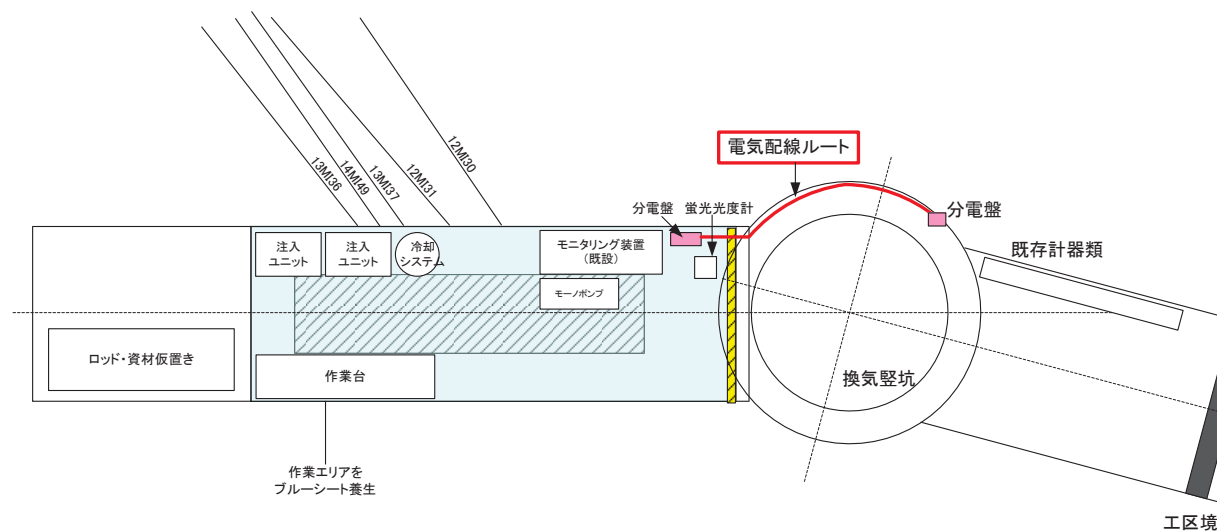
高粘性流体試験の実施位置と仮設状況
